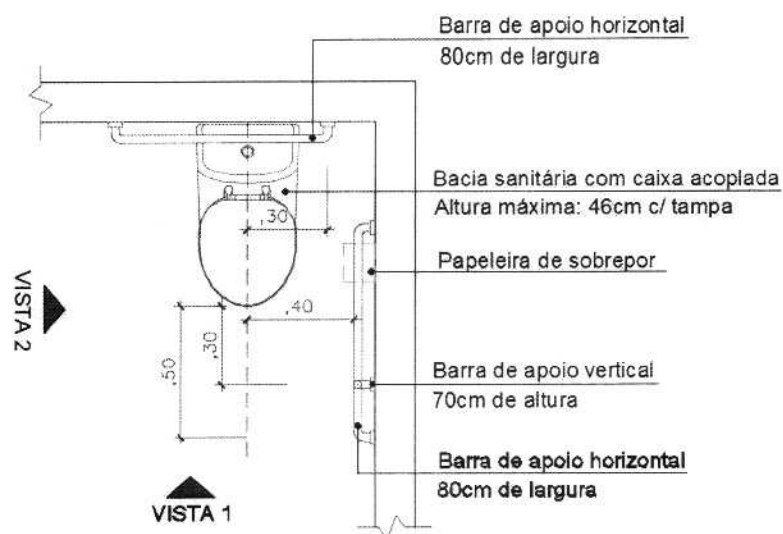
Planta baixa - detalhe de instalação da bacia sanitária
